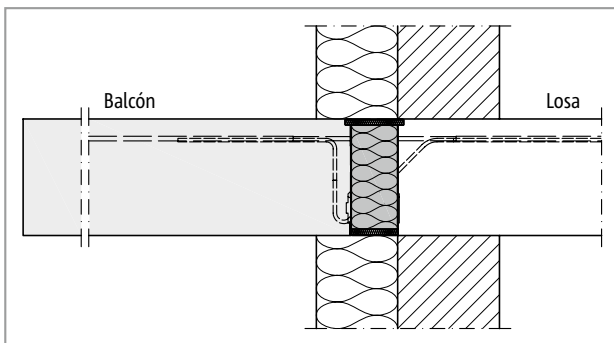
Schöck Isokorb® T tipo Z, K: Sistema de aislamiento térmico exterior (SATE)
